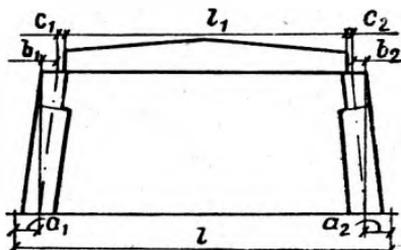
Схема стропильной фермы, свободно опирающейся на колонны
